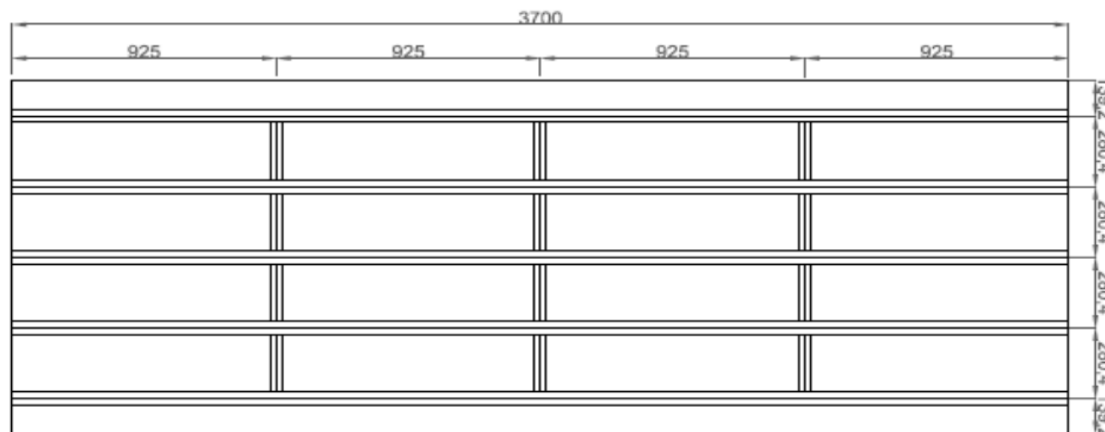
Seção longitudinal da ponte com cotas em centímetros
